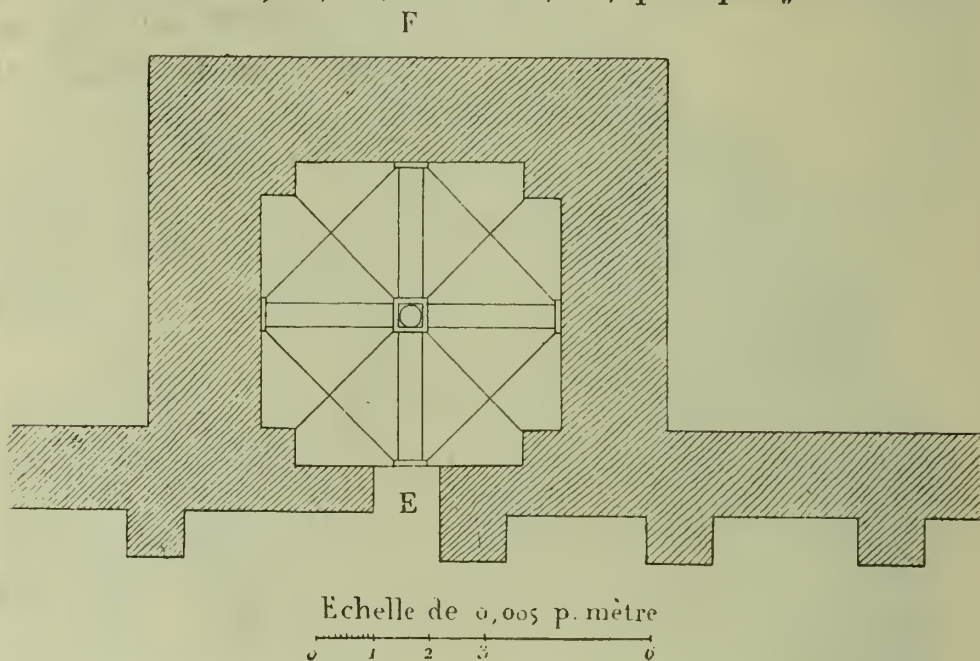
Bordj-Hallal. Forteresse byzantine. Plan d'une tour de l'enceinte (Dessin de M. Sadoux.)
